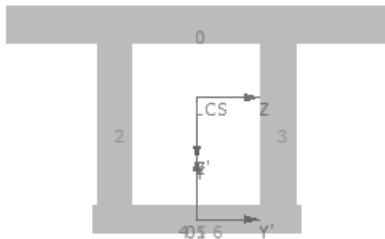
Поперечний переріз досліджуваної прогонової будови
